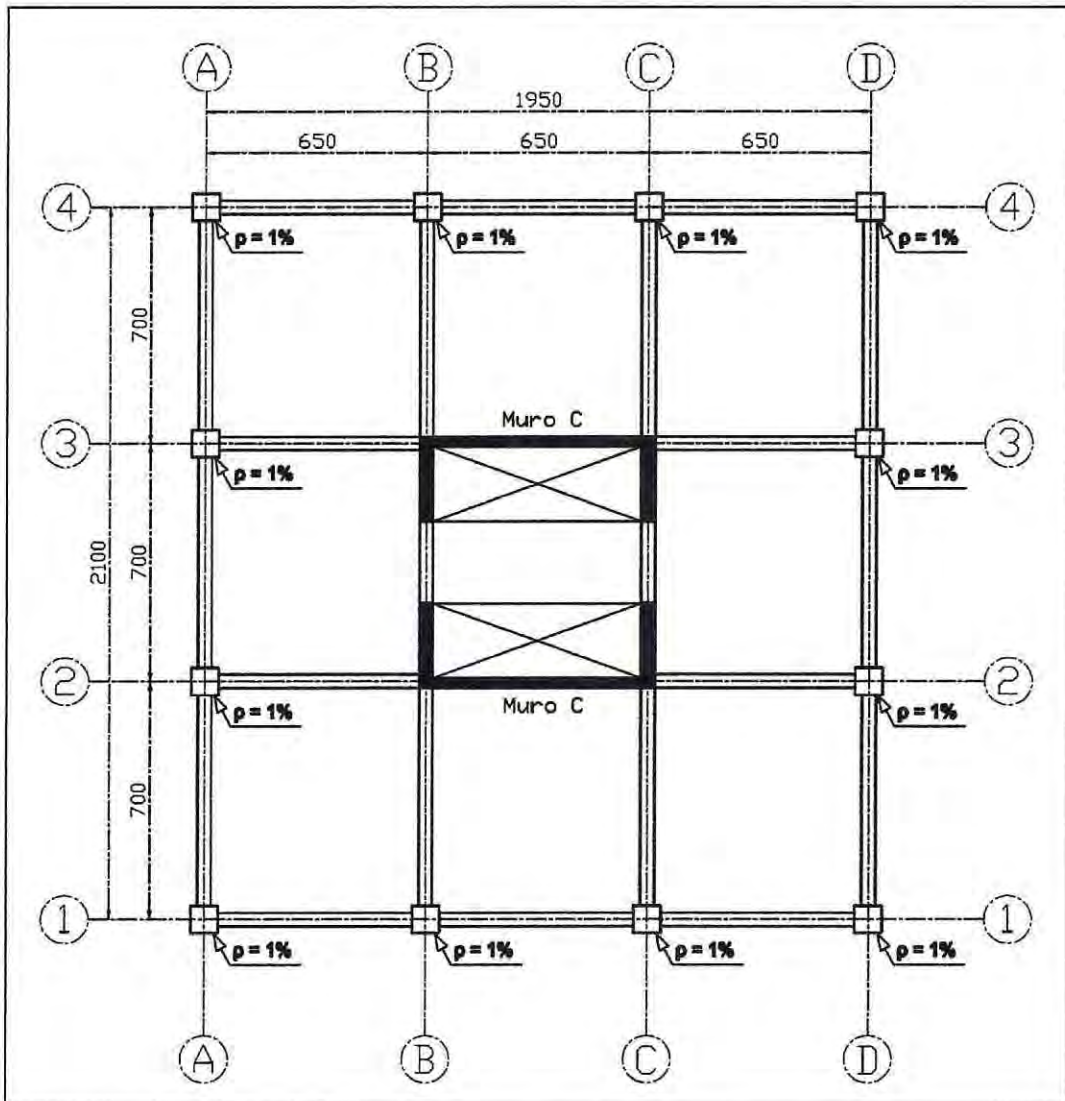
Planta de ubicación de columnas y muros en sistema mixto.
